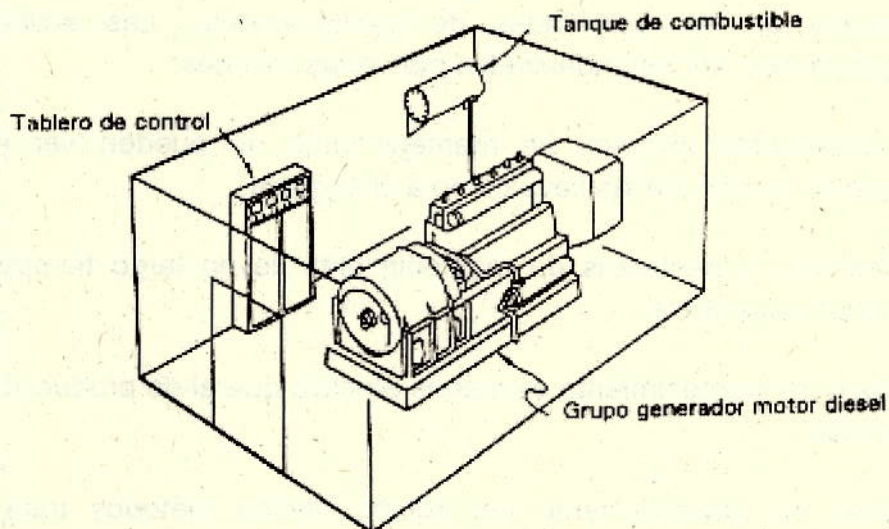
VISTA DE LAS PARTES PRINCIPALES DE UNA PLANTA DE EMERGENCIA
